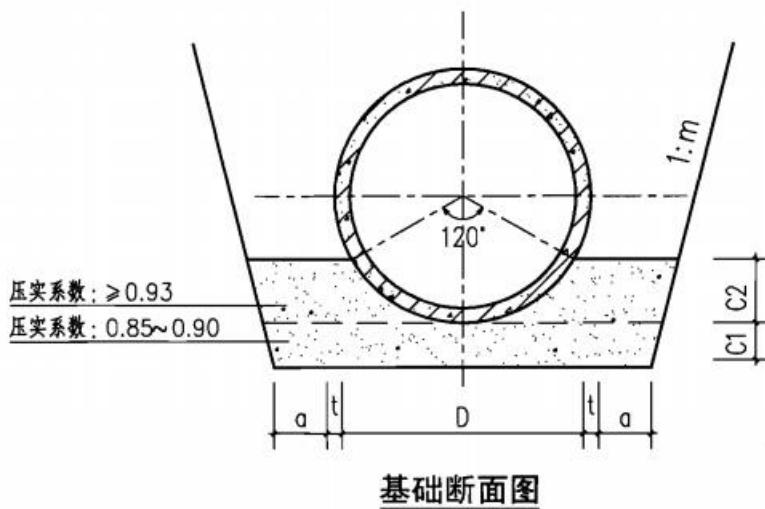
4D500~D1650 承插口钢筋混凝土管道基础断面图
